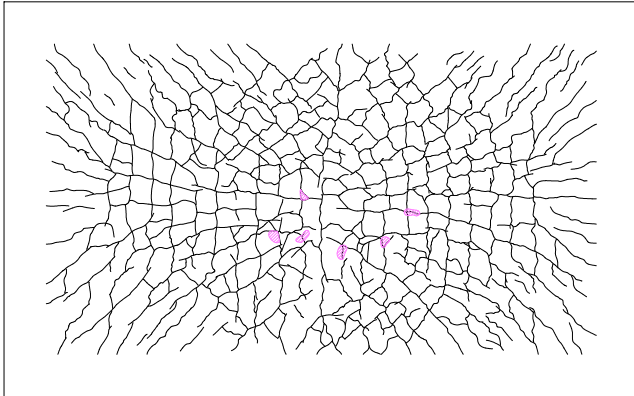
供試体CF2の補強前の床版下面のひび割れ状況（初期損傷終了時、上面からの透視図）
